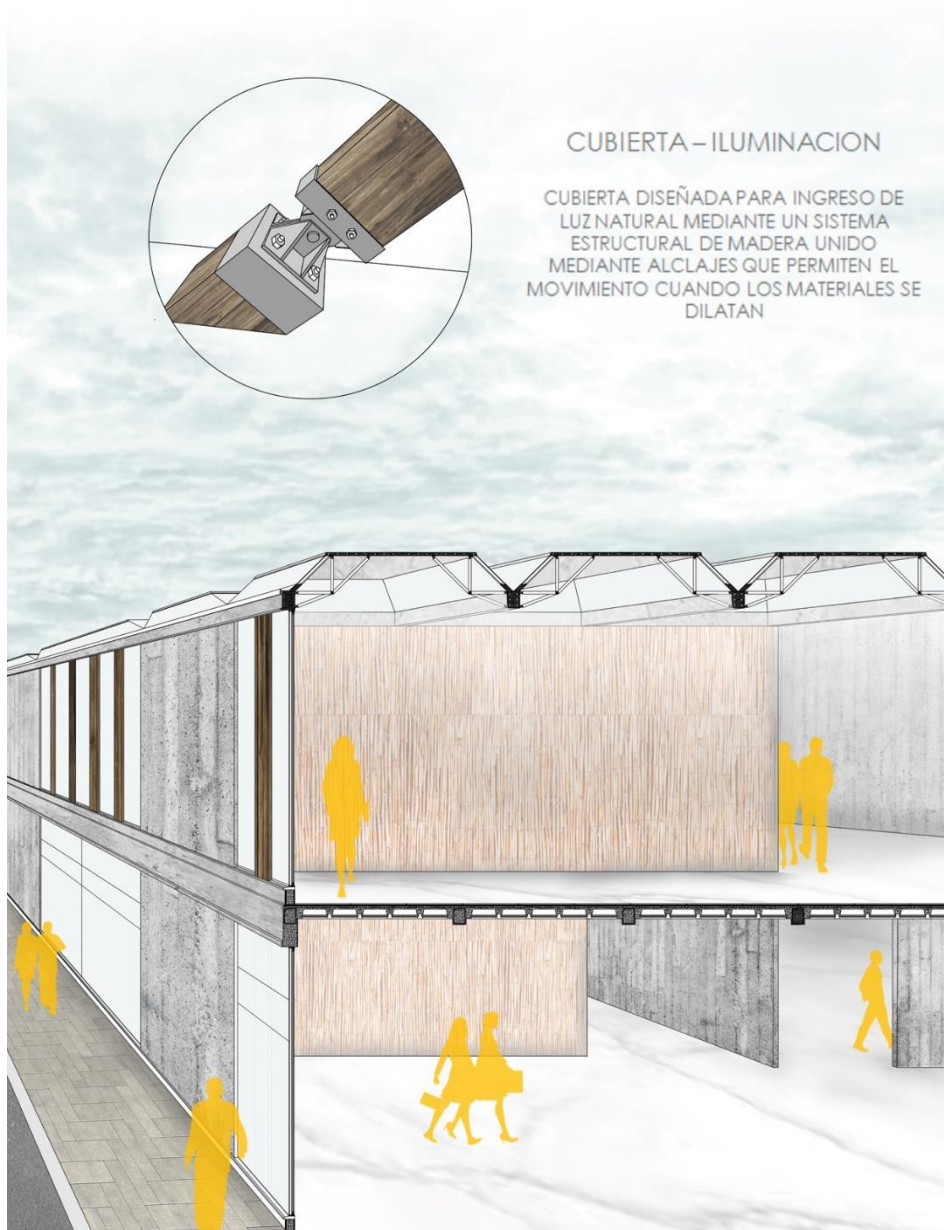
Corte fugado – Detalle constructivo. Elaboración propia.
